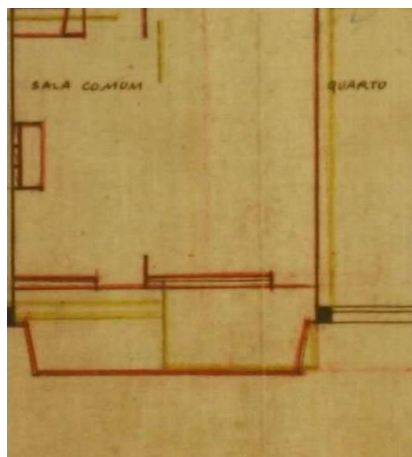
Fotografia de pormenor das varandas do alçado principal do prédio Pinto Leite. Fig. 144. Pormenor de varanda em planta.
